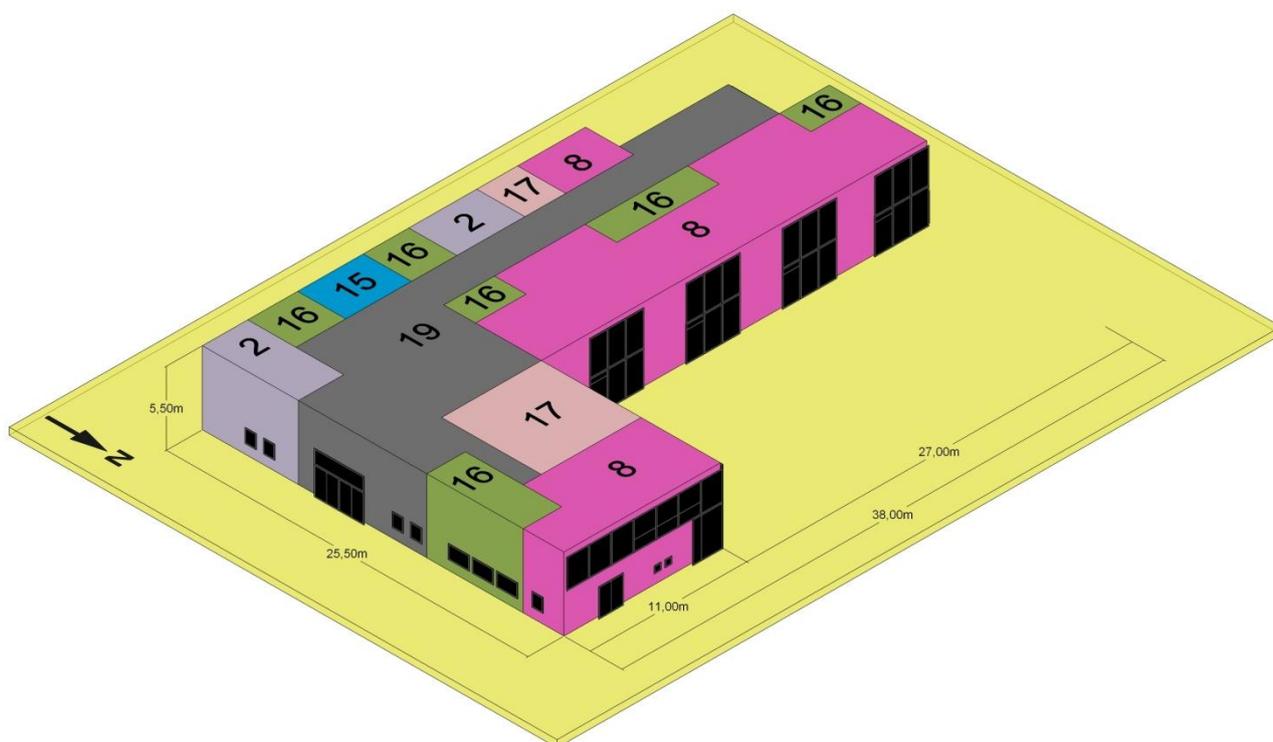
Kindergärten – Darstellung Zonen – Ansicht Nord-Ost
